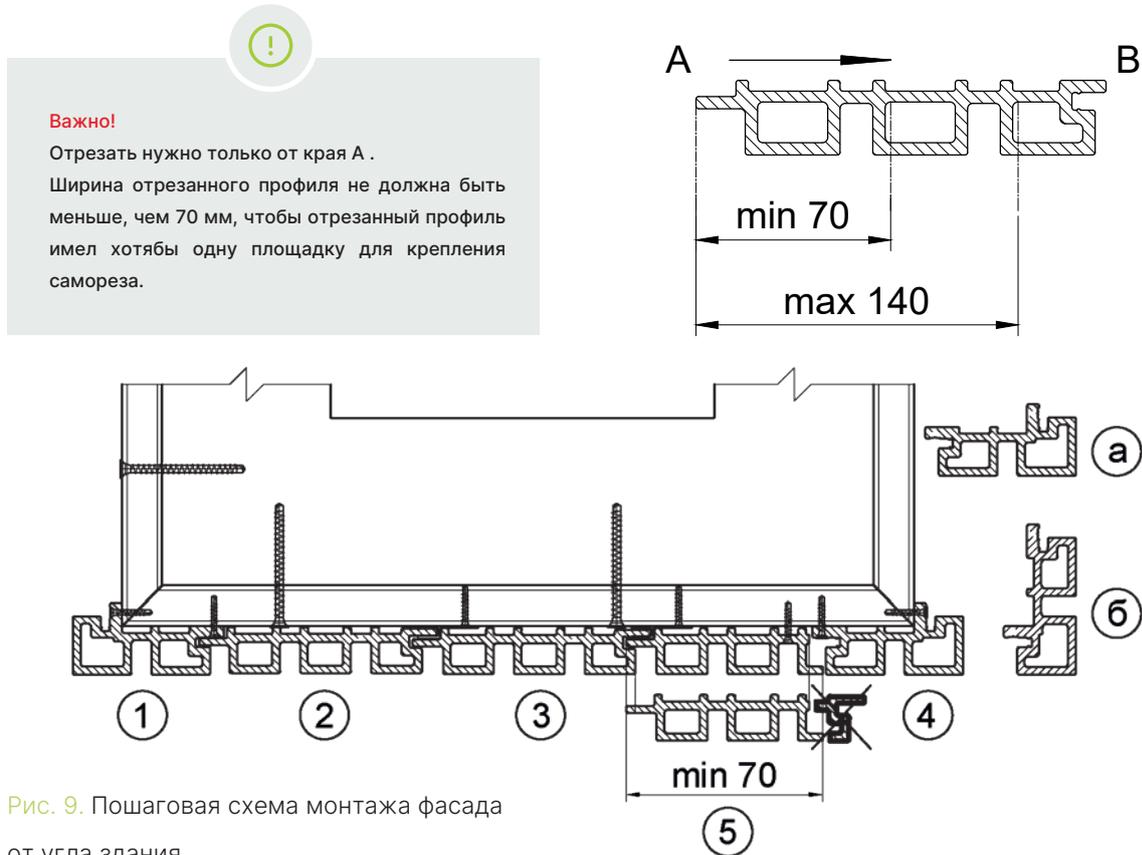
Пошаговая схема монтажа фасада от угла здания
